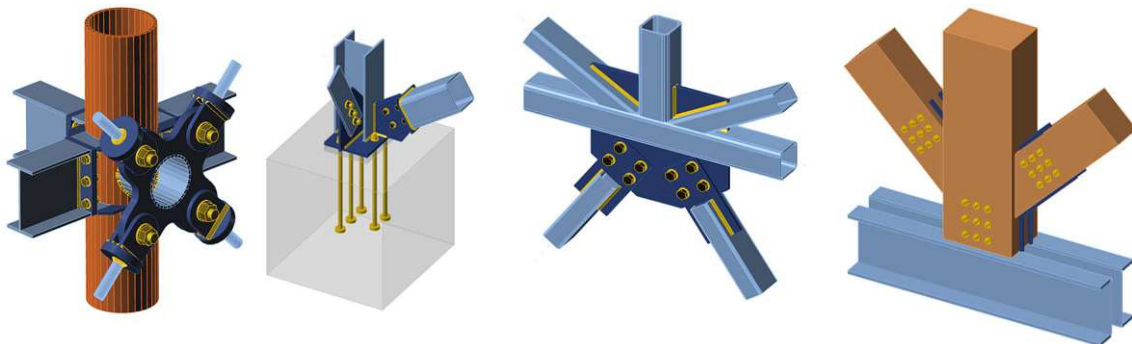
Typische Knotengeometrien als Stahl- Beton- und Holzanschlüsse eingegeben werden [18].
